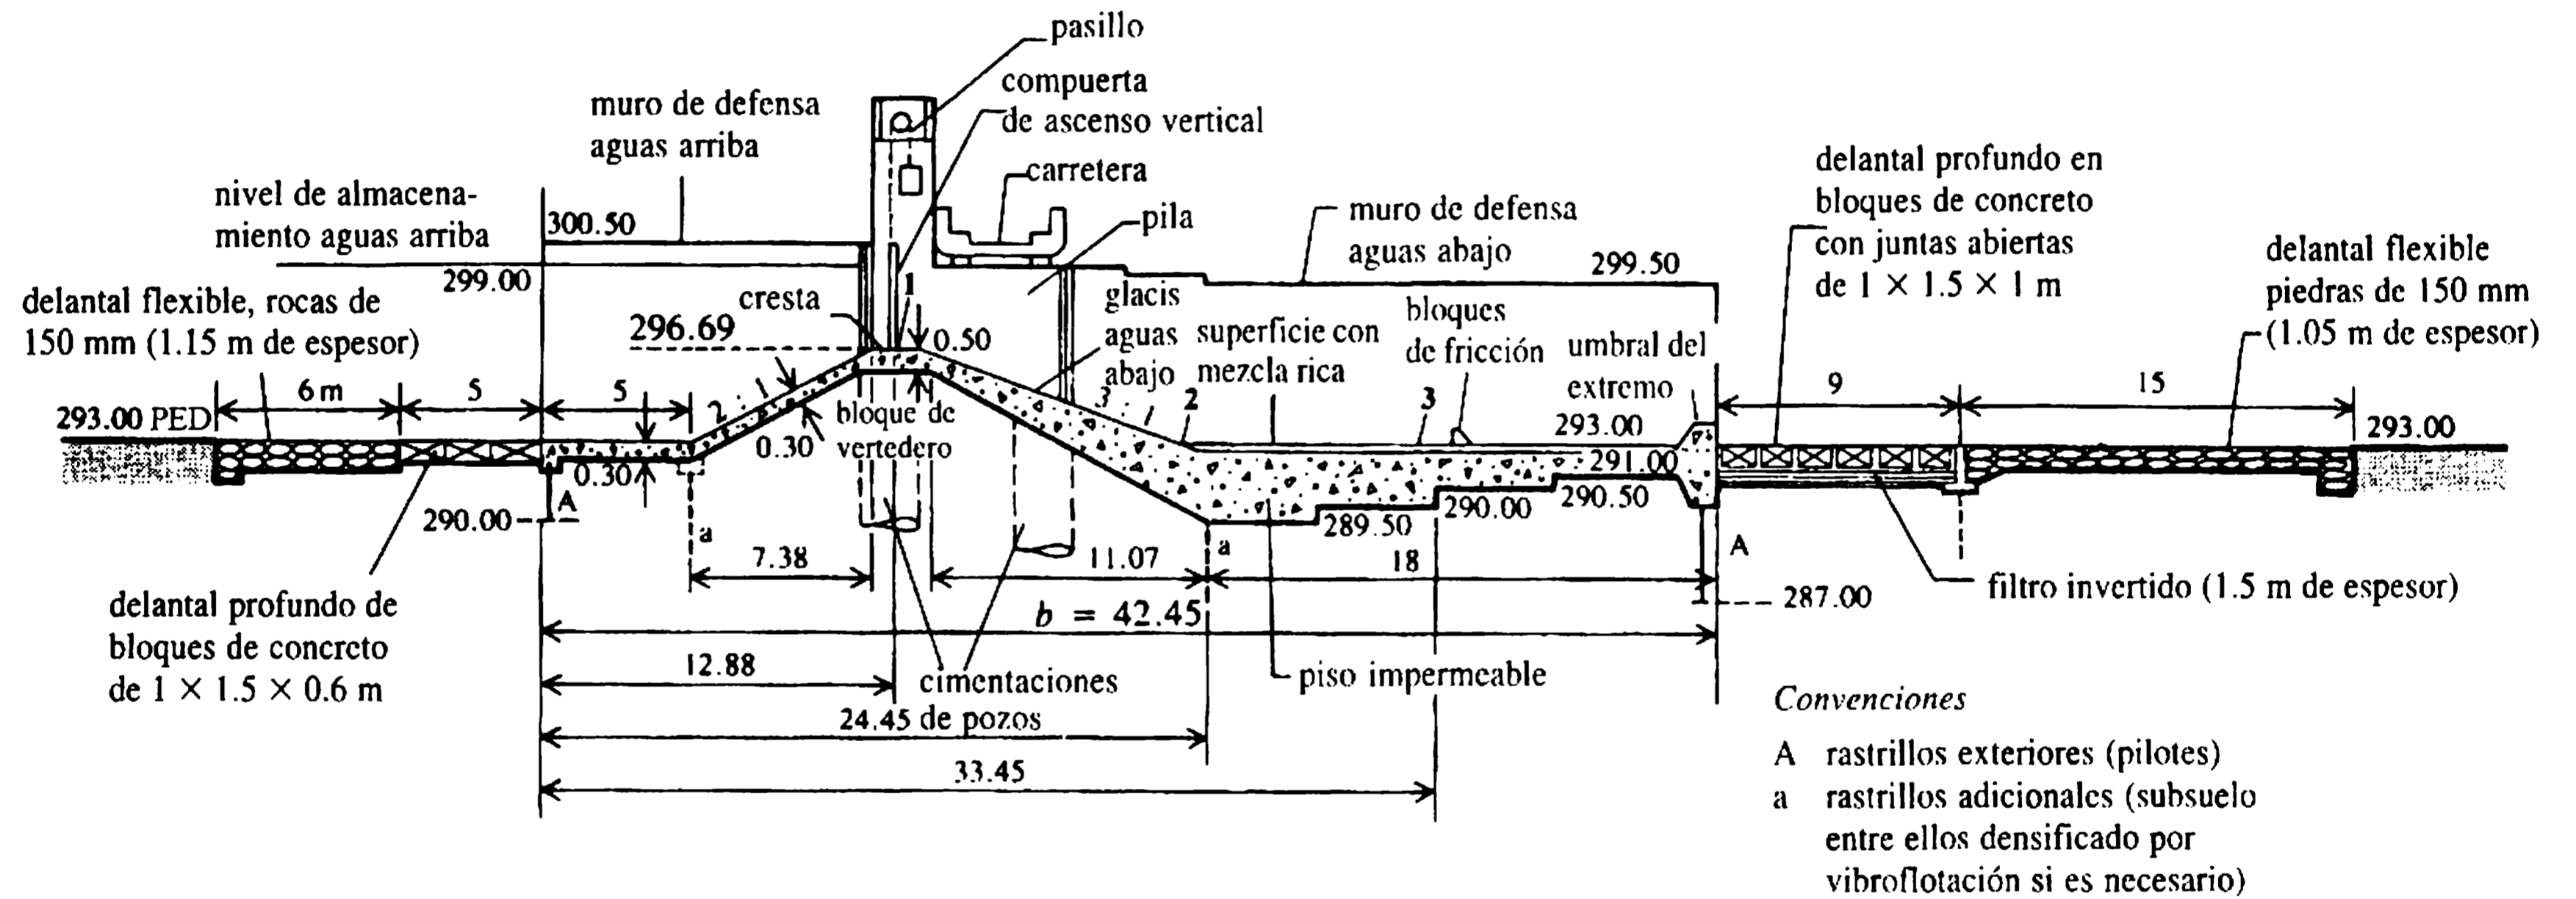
Sección transversal a través de la barrera que muestra detalles de las cimentaciones; todas las dimensiones están en metros.
